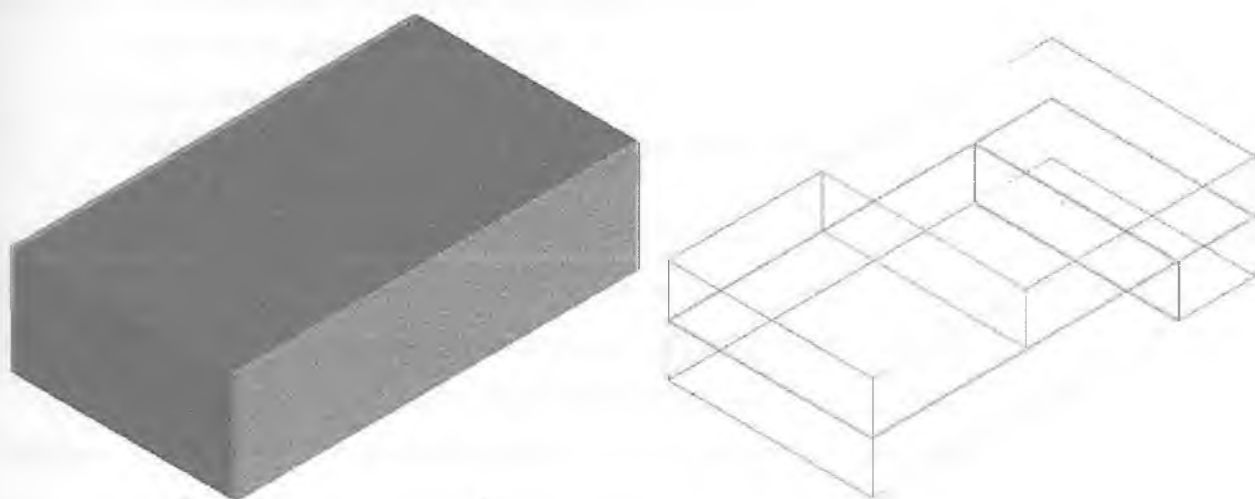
Расчетная схема кладки из ячеистобетонных блоков
